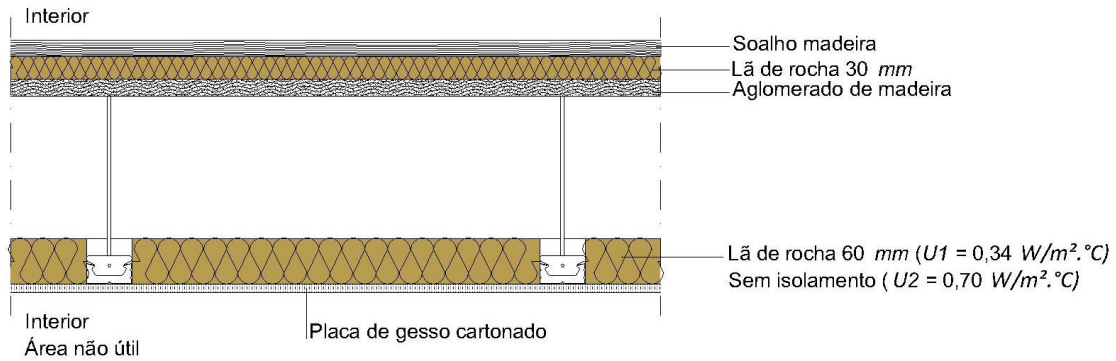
Pormenor construtivo Pavimento PAV1
